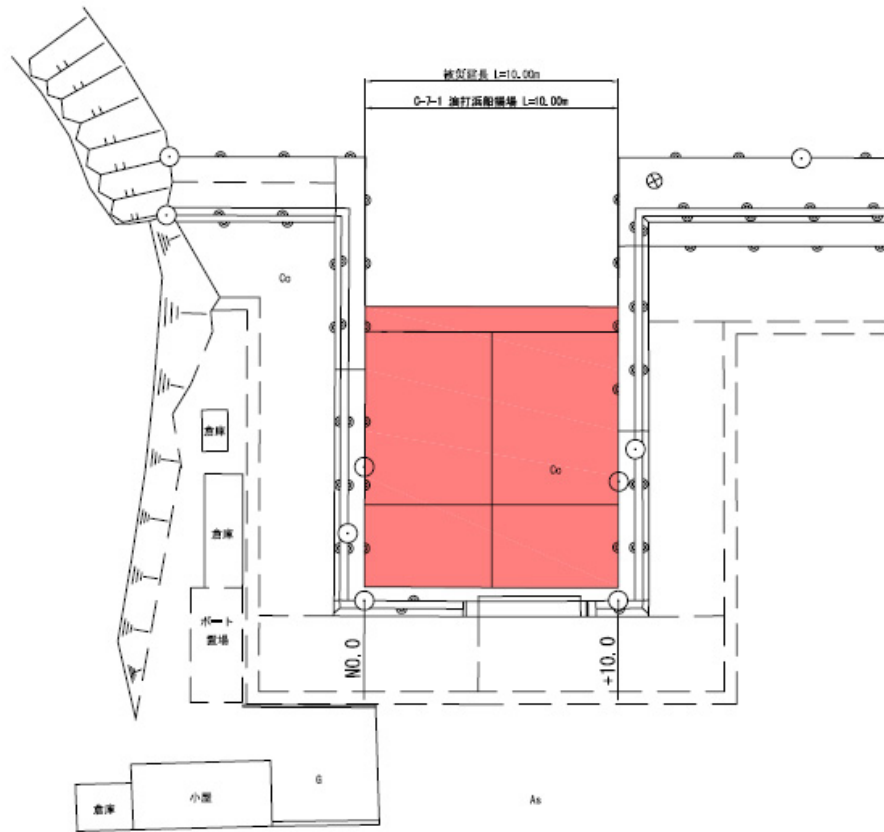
No.6 浪打浜船揚場の平面図（被災後）
